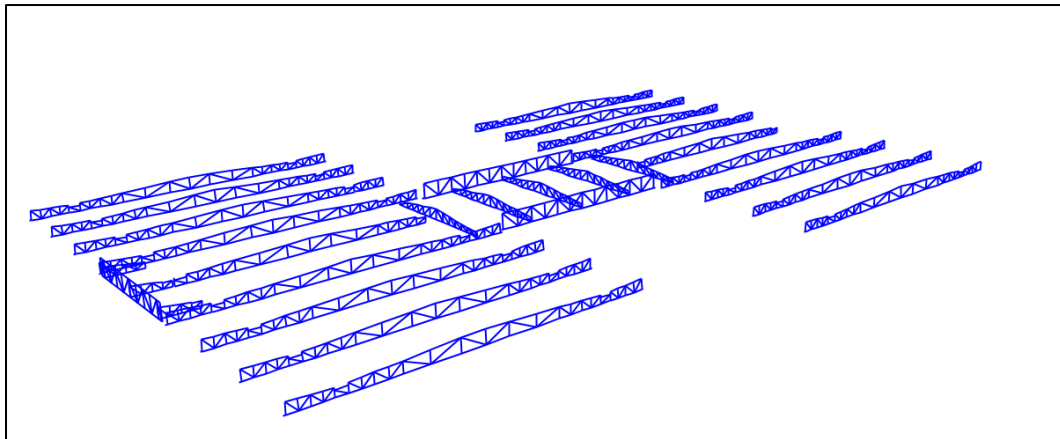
Modelo de Cálculo 1 - Treliça Metálica
